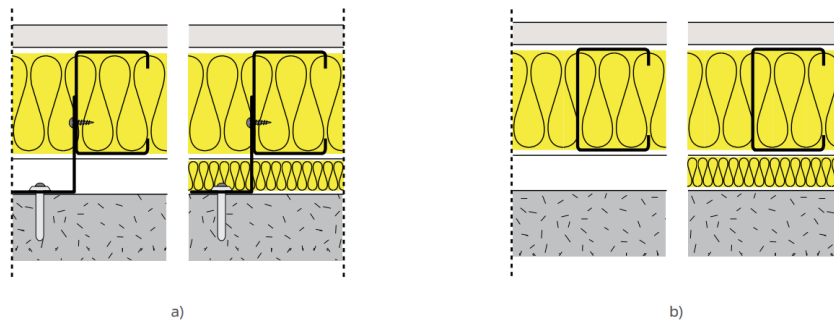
Muro trasdosado autoportante a) fijación puntual al muro, b) estructura independiente.
